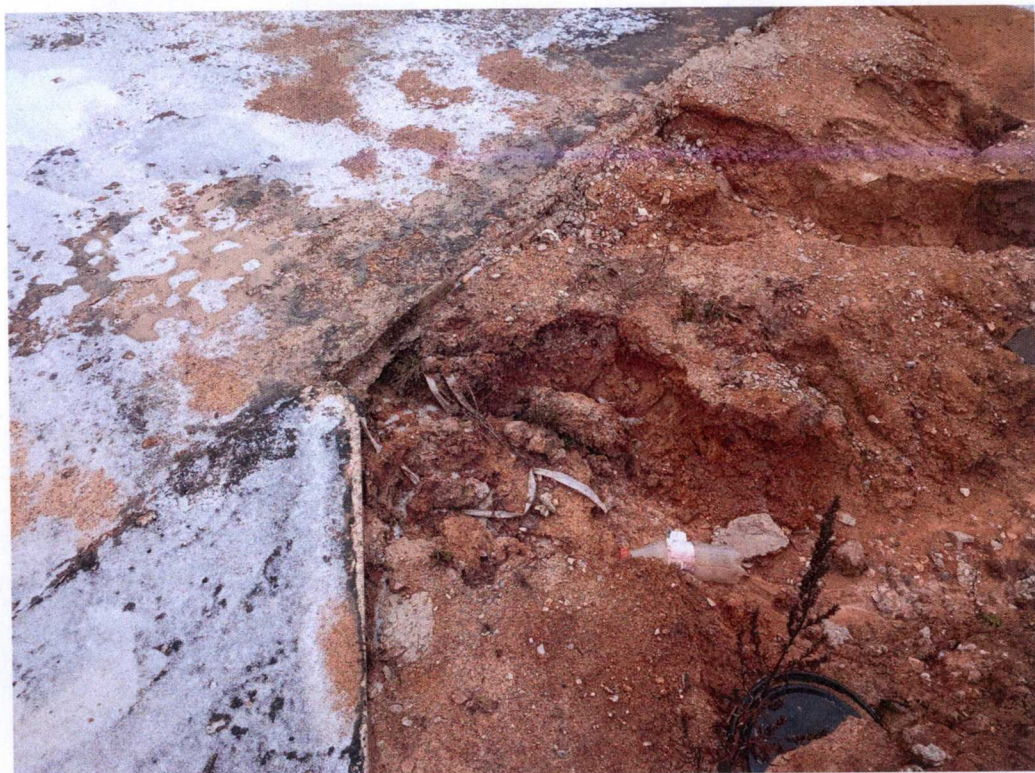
Вымывание грунта из-под бетонной подготовки по оси «35/3» в зоне секций 1,2
